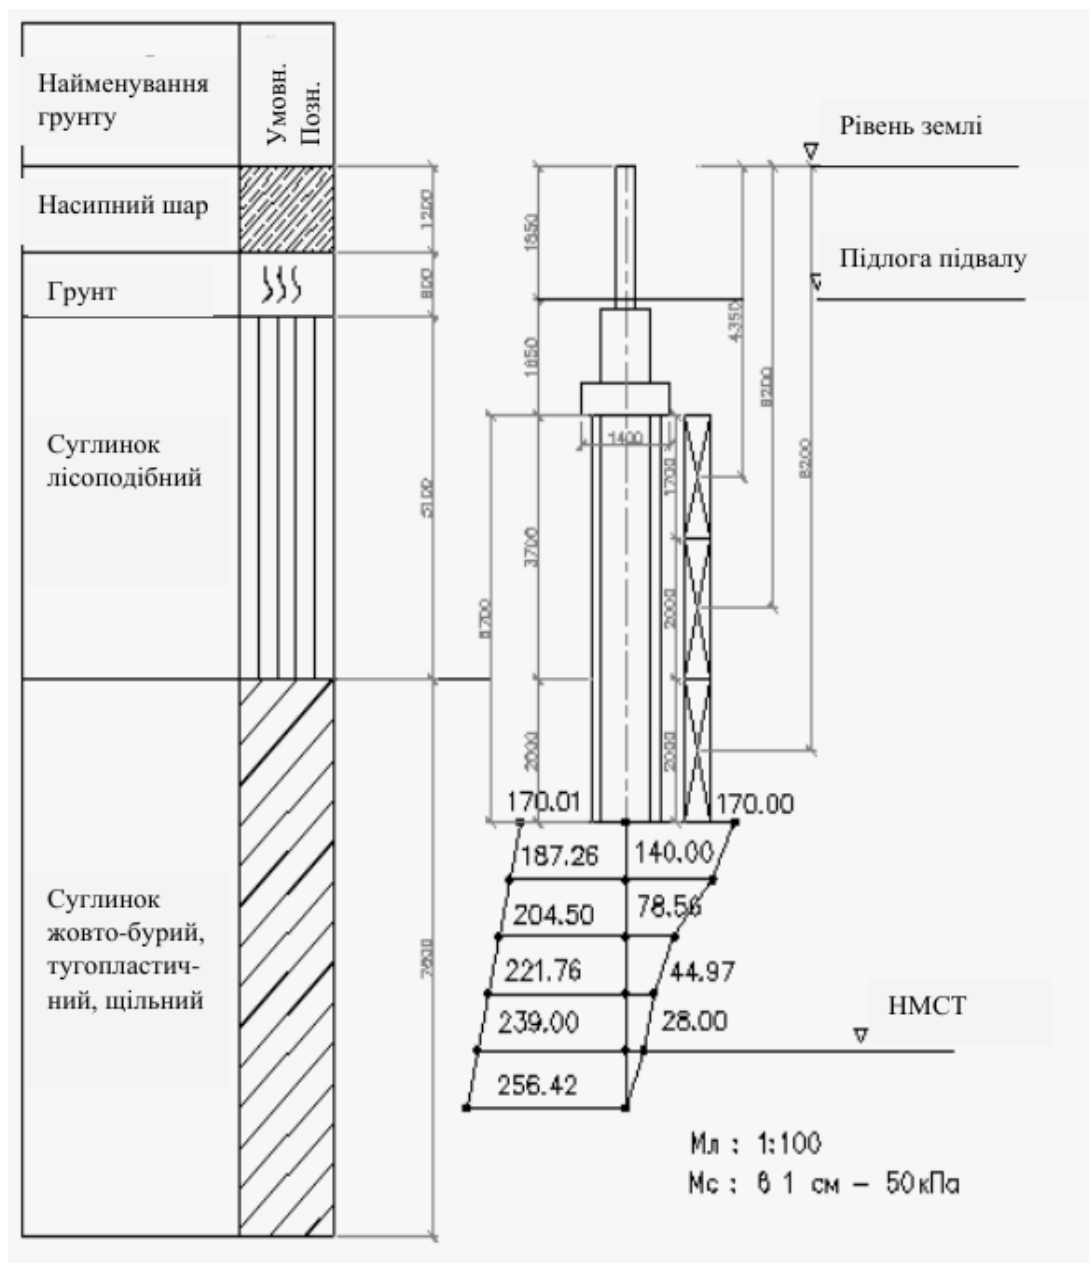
Розрахункова схема пальового фундаменту під колону
